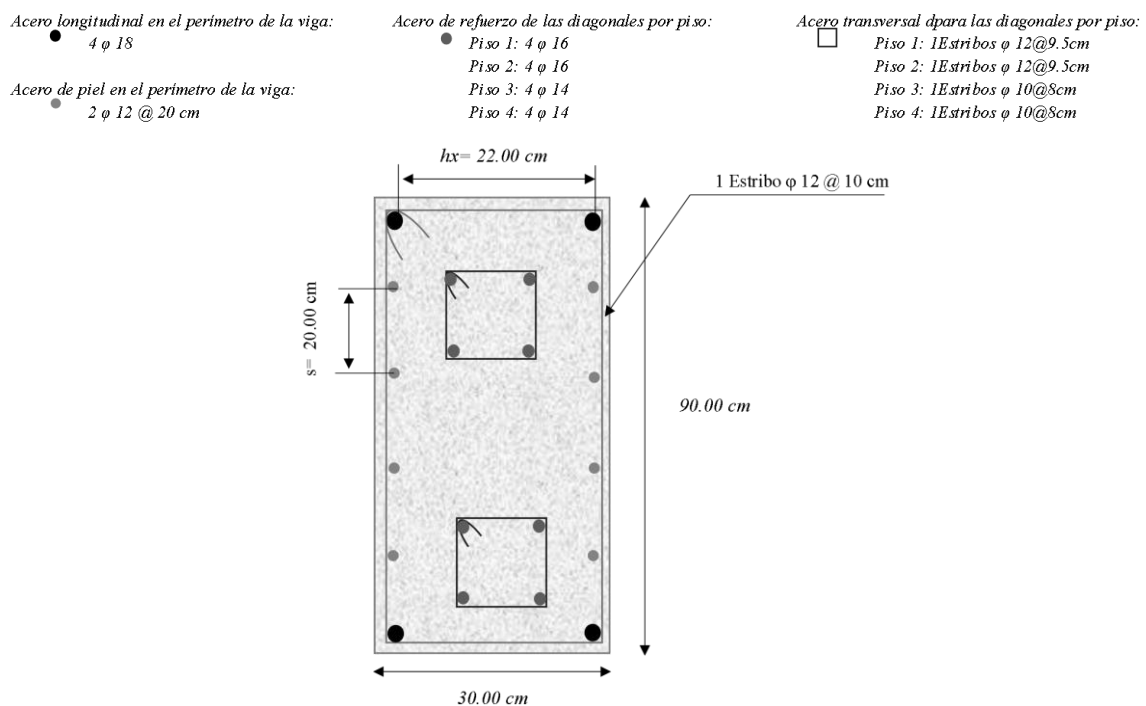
Armado de las vigas de acople de la geometría 2 en base al FBD
